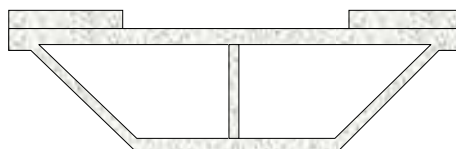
Puente con vigas cajón con celdas trapezoidales
